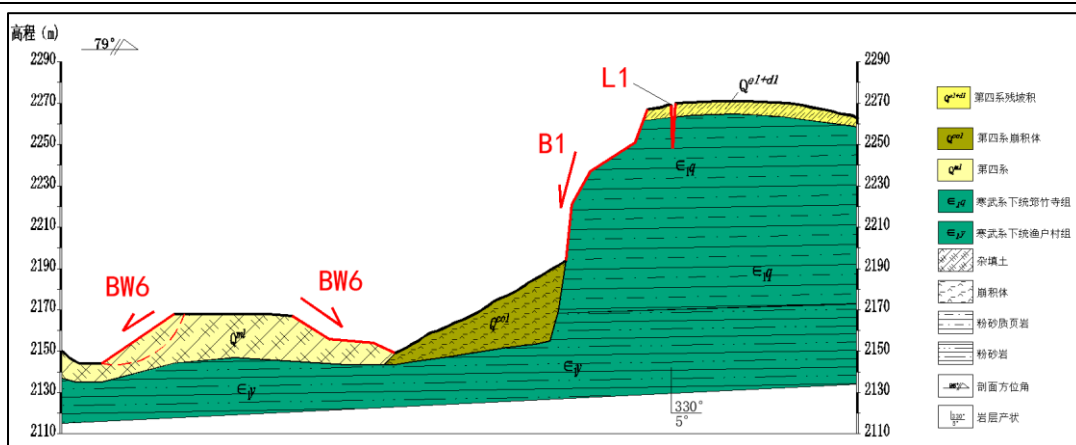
L<sub>1</sub> 地裂缝剖面图
